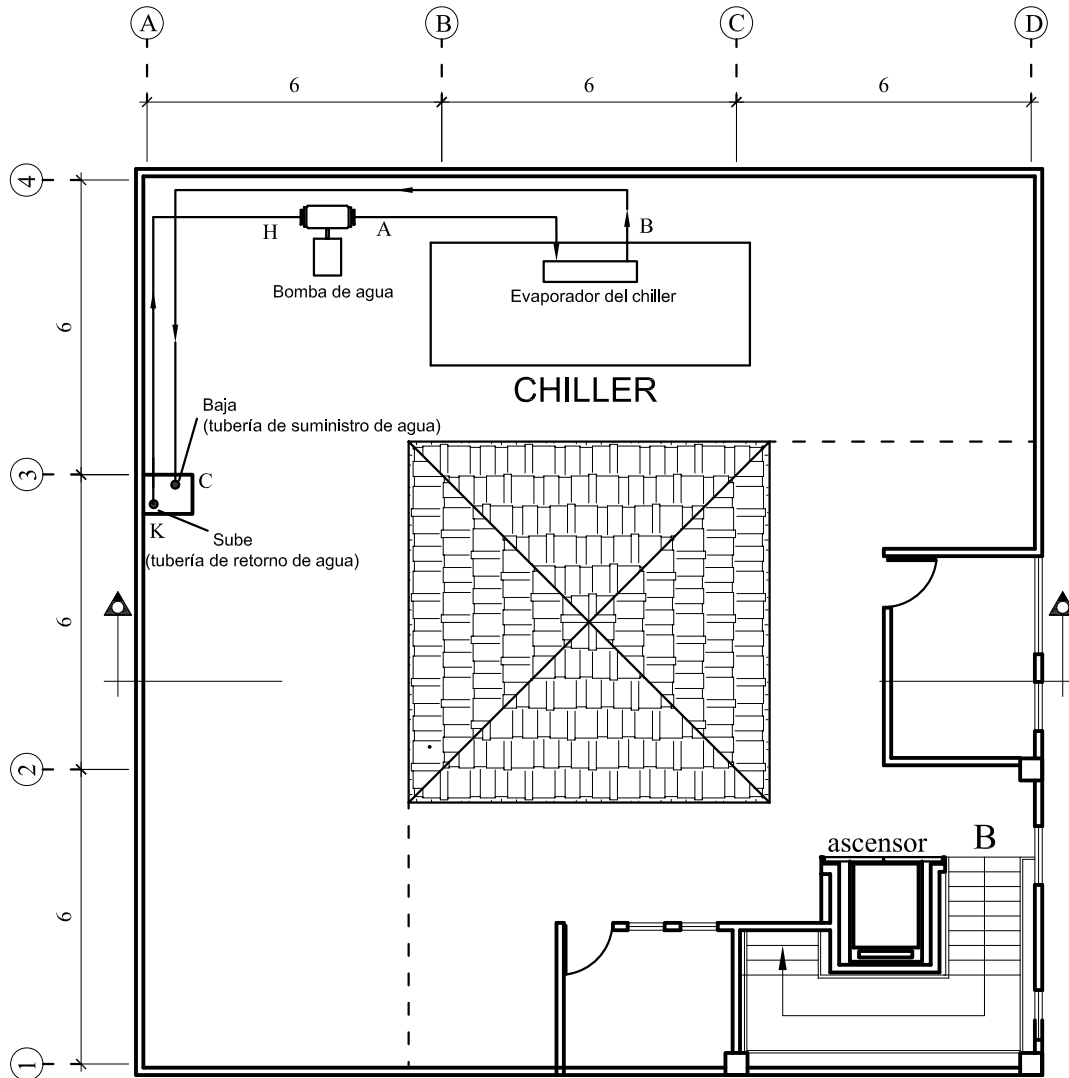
Plano de la planta de la terraza del edificio para ejemplo hidráulico.
